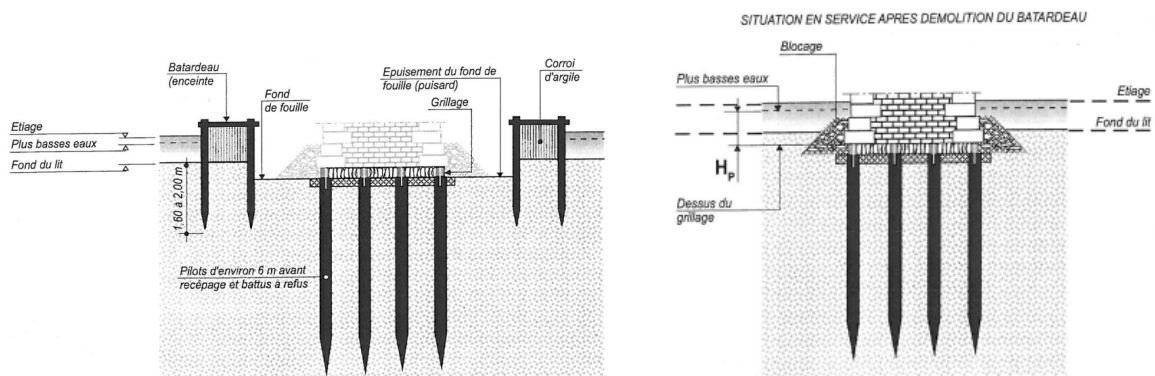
Principe de construction des fondations par Perronet (Maillard, 2006)
